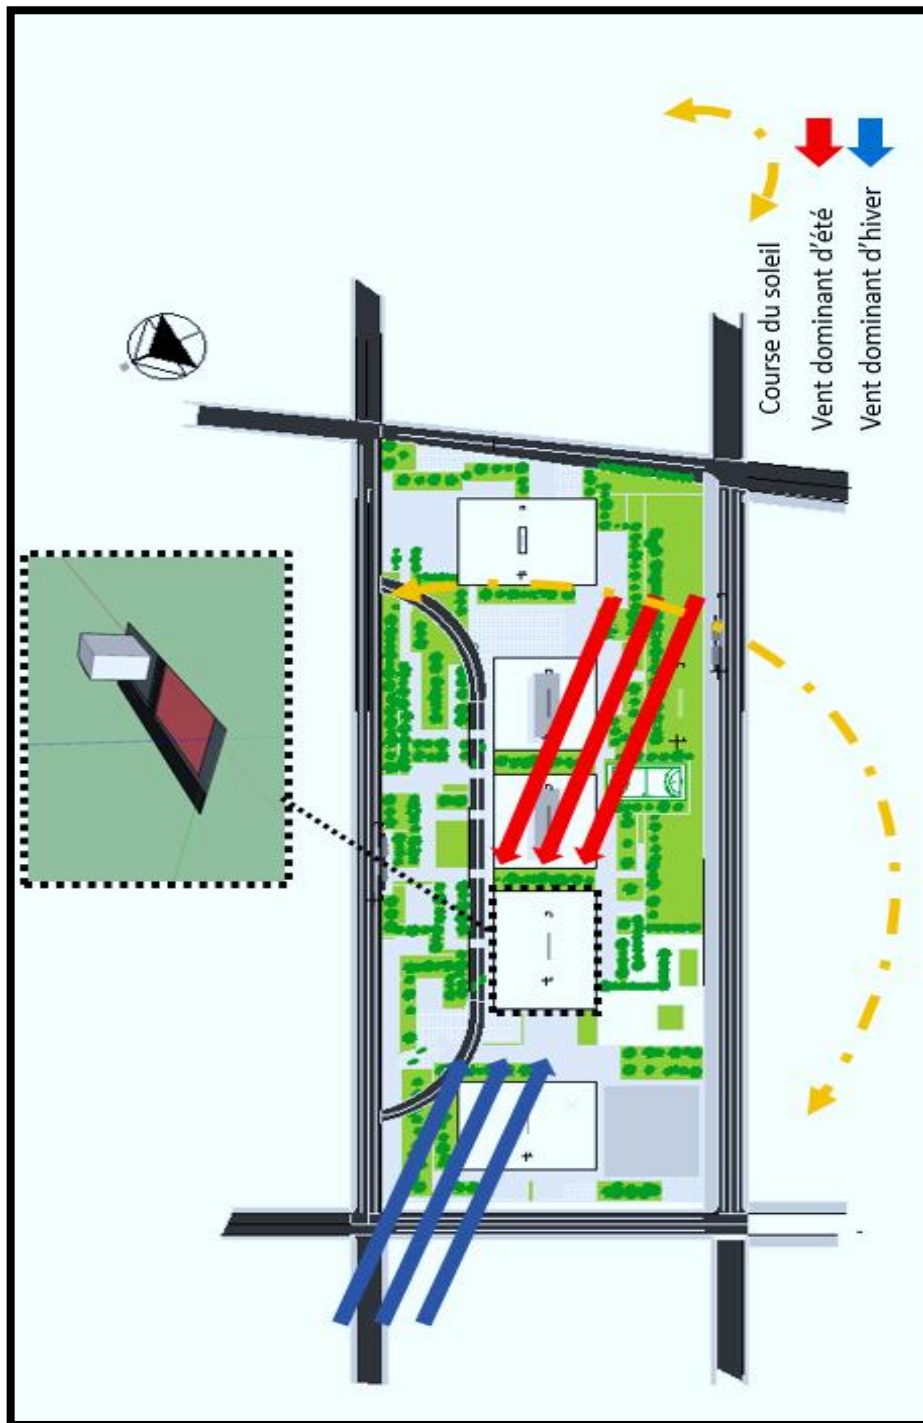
Schéma de structure et Proposition d'aménagement
